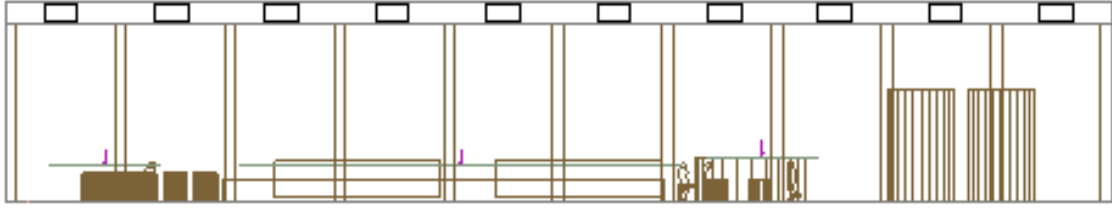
Propuesta 2, vista en planta. Fuente: DIALux
